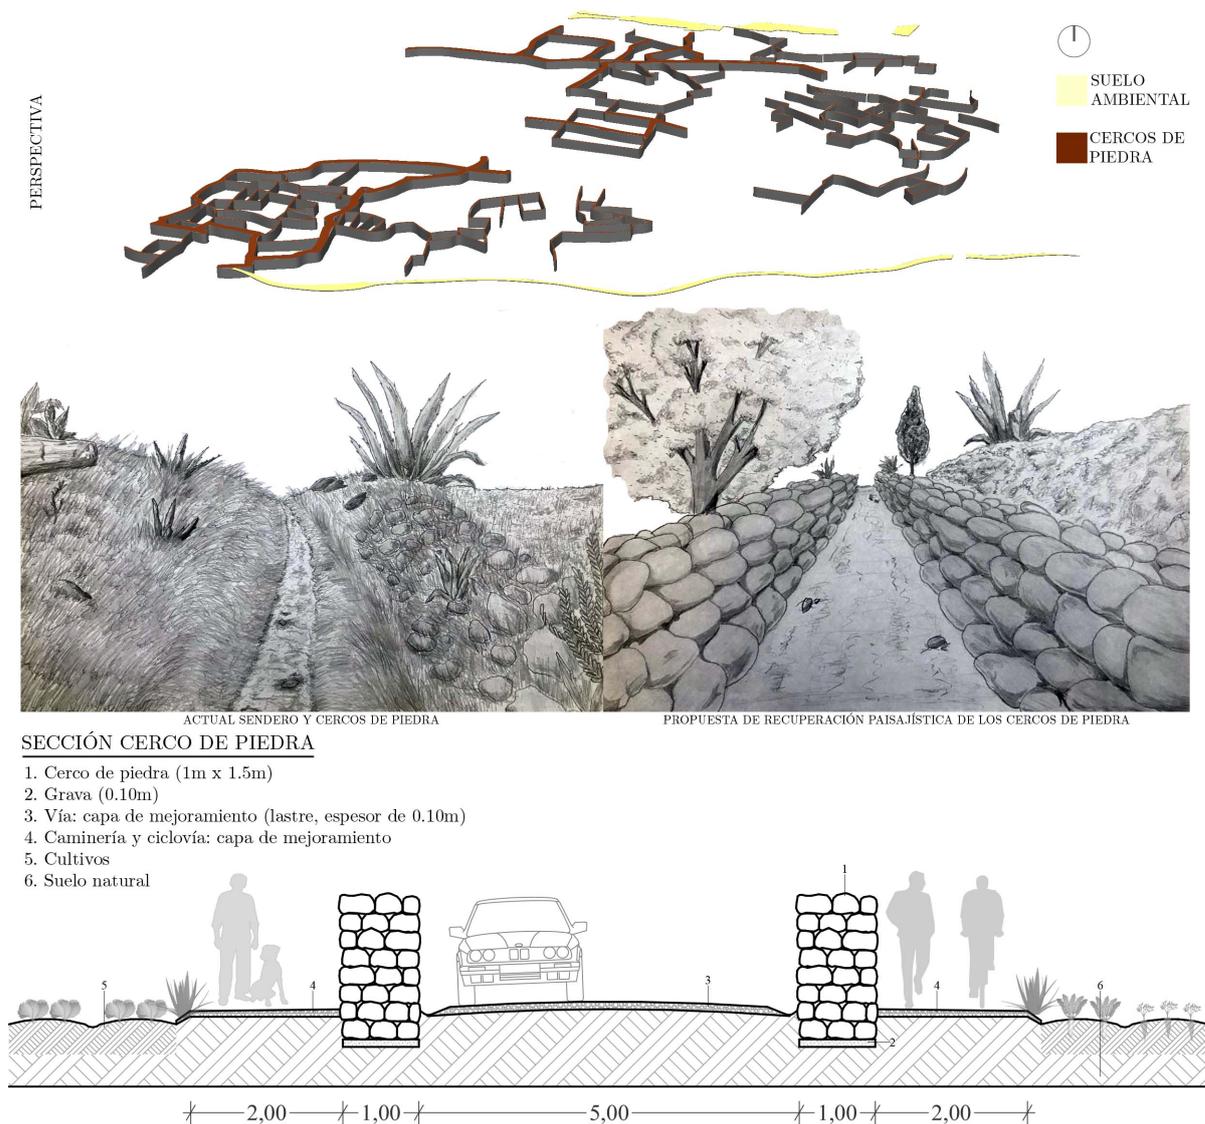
Propuesta de recuperación paisajística y sección de cerco de piedra con vía.
